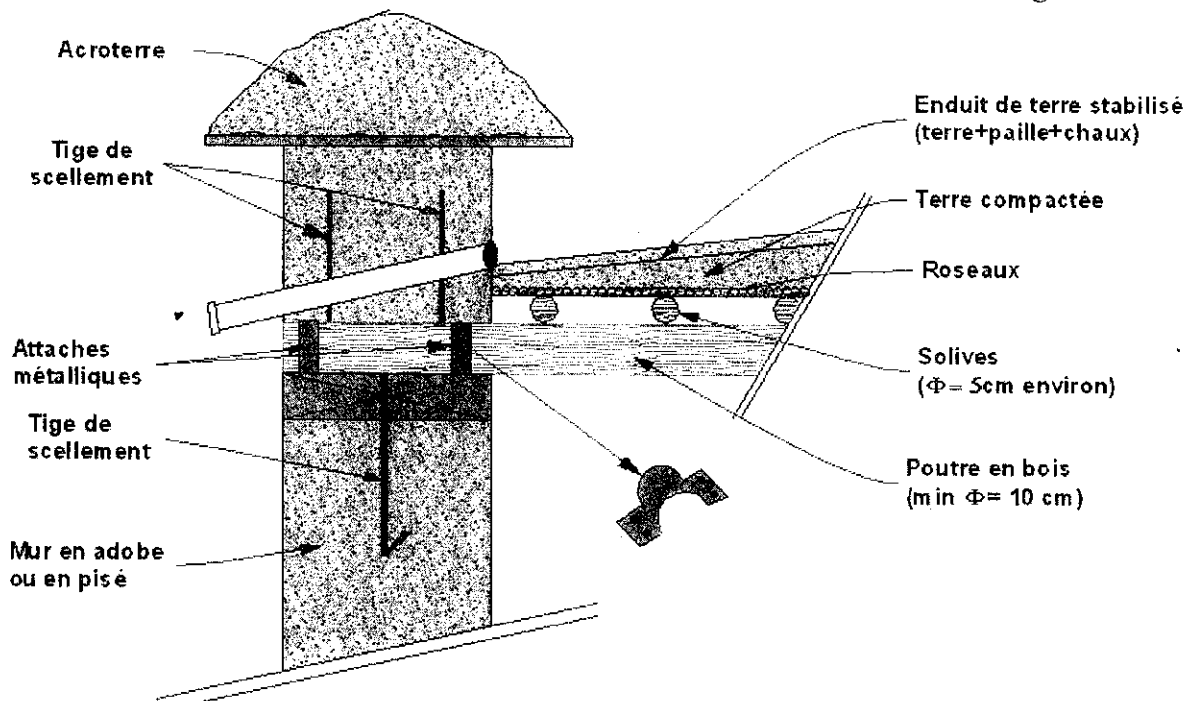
Chaînage horizontal en bois, toiture traditionnelle et attache mur – chaînage
